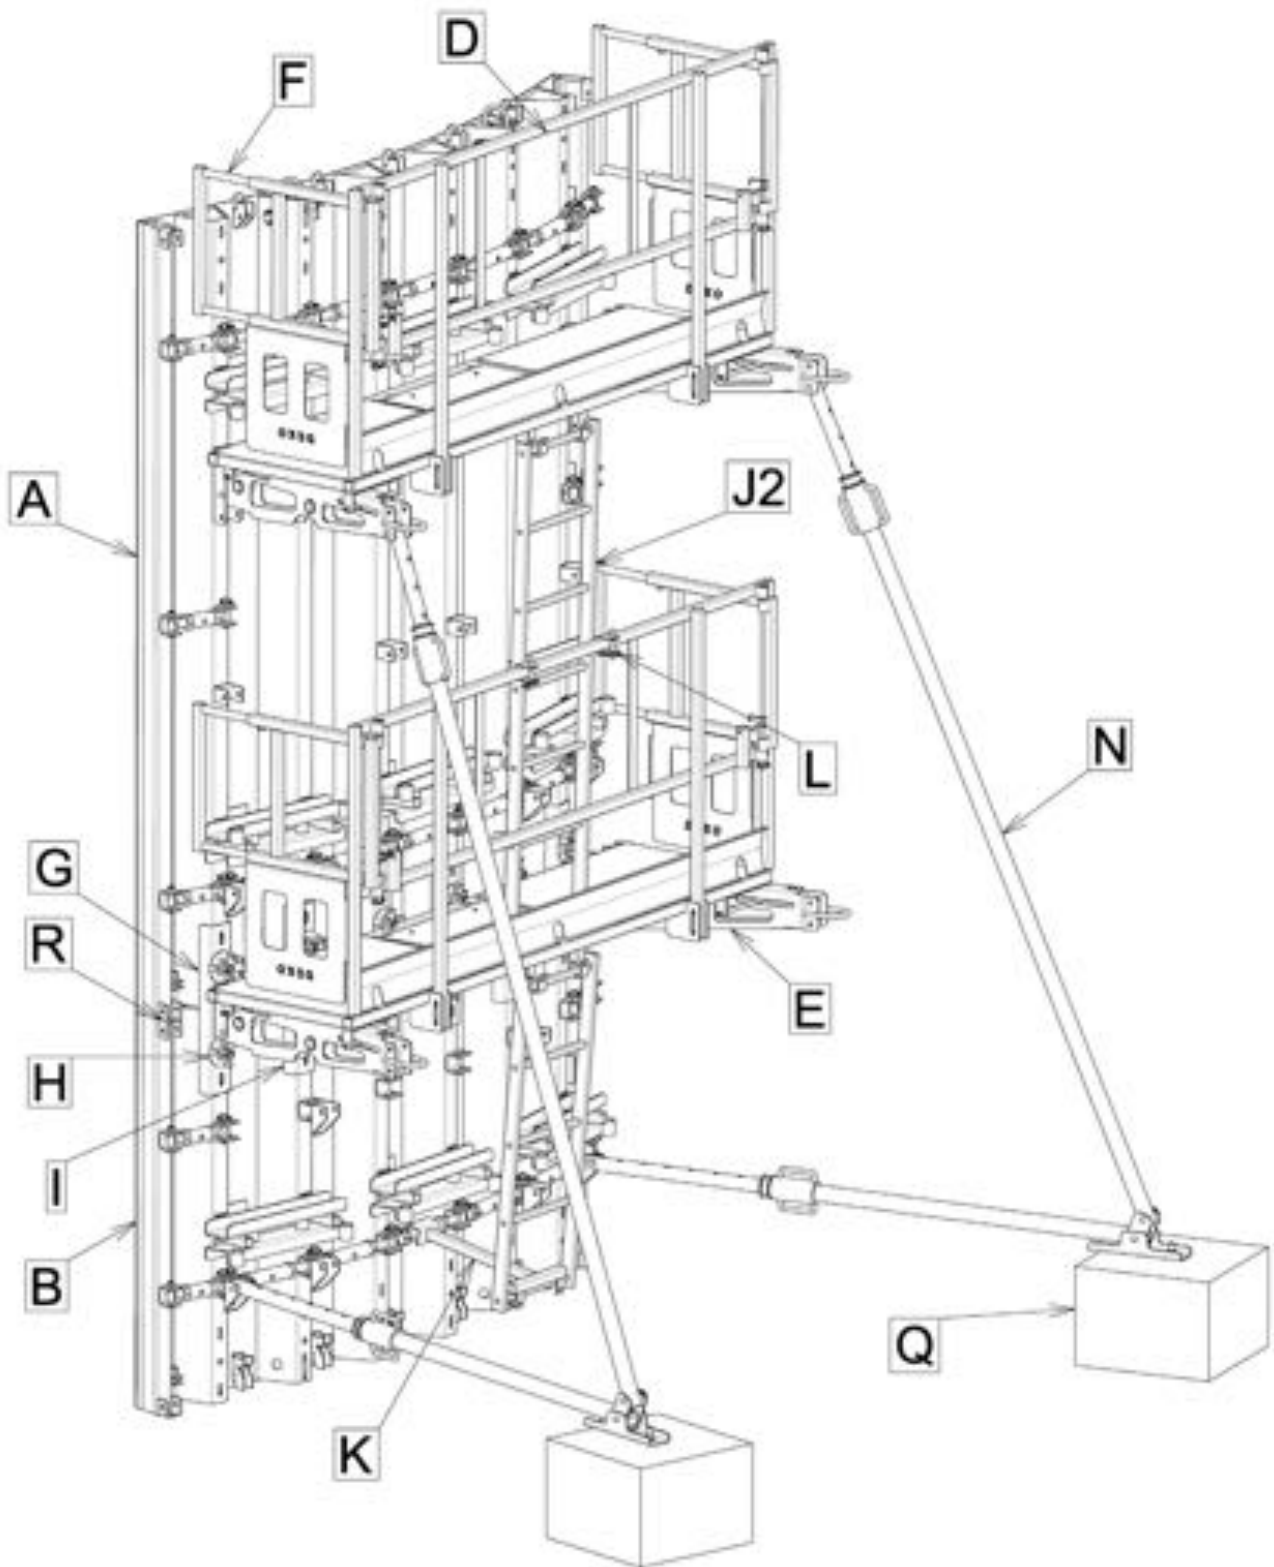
Assemblage d'une banche de 280 avec une sous-hausse de 140
